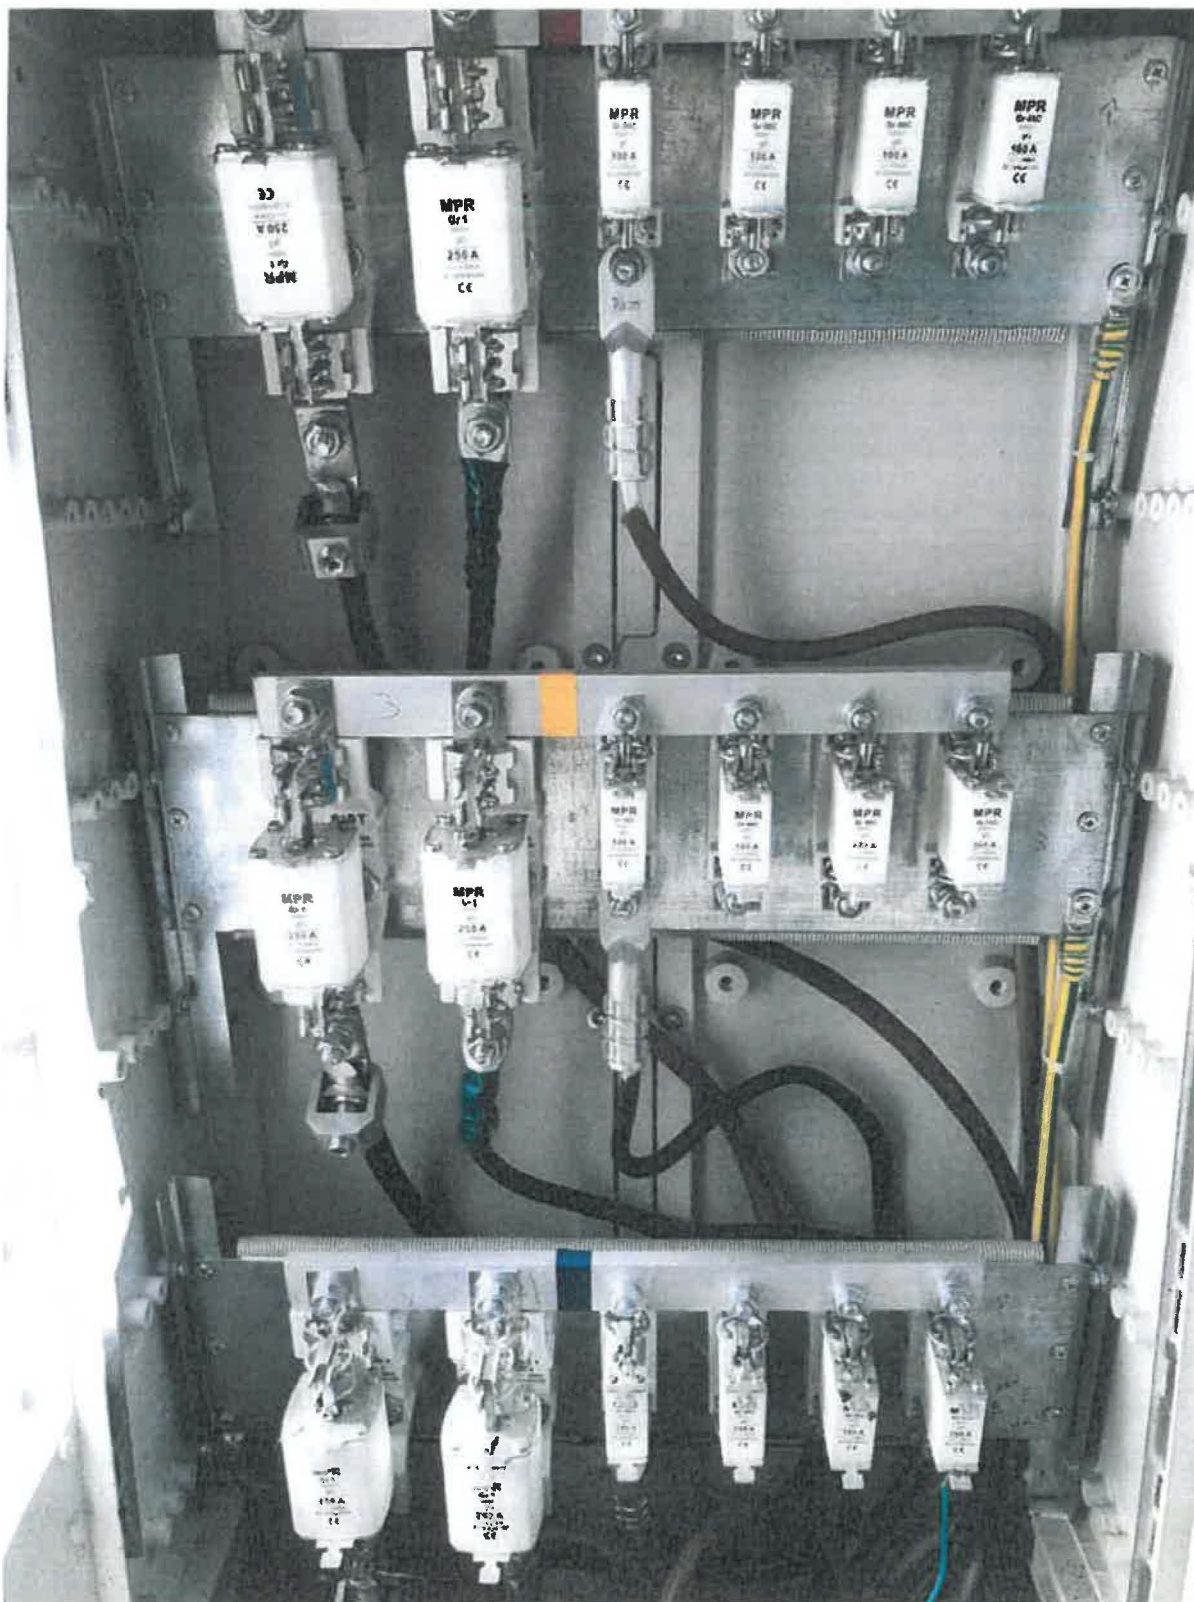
Frida III instalata in amonte de pavilion (in liziera) I, pentru alimentarea pavilion I + St. de Oxigen.
